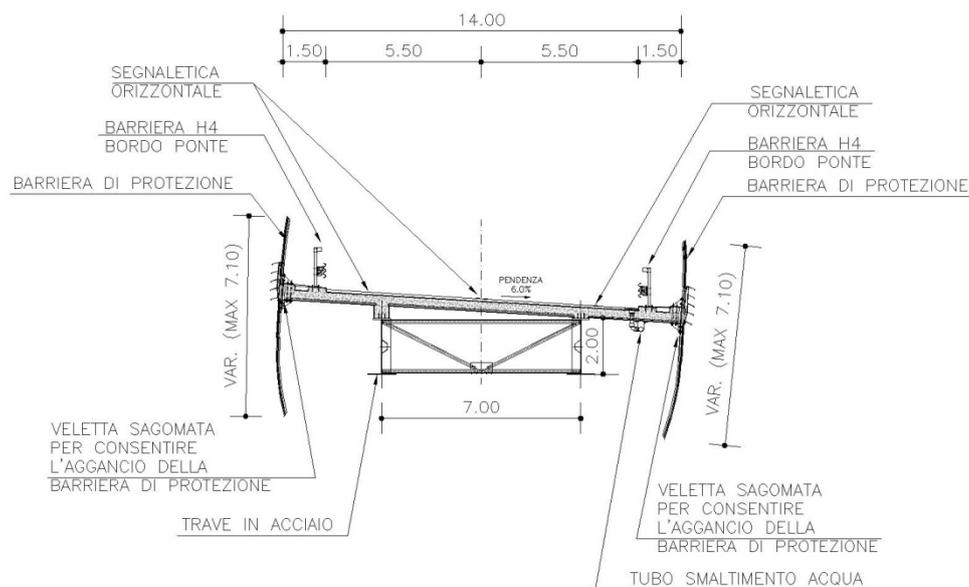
impalcato bidirezionale metallico – sezione tipo
